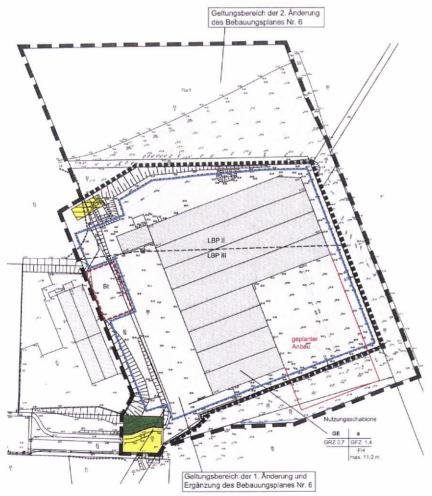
Geltungsbereich der 2. Änderung mit Darstellung der Ziele der 1. Änderung und Ergänzung
